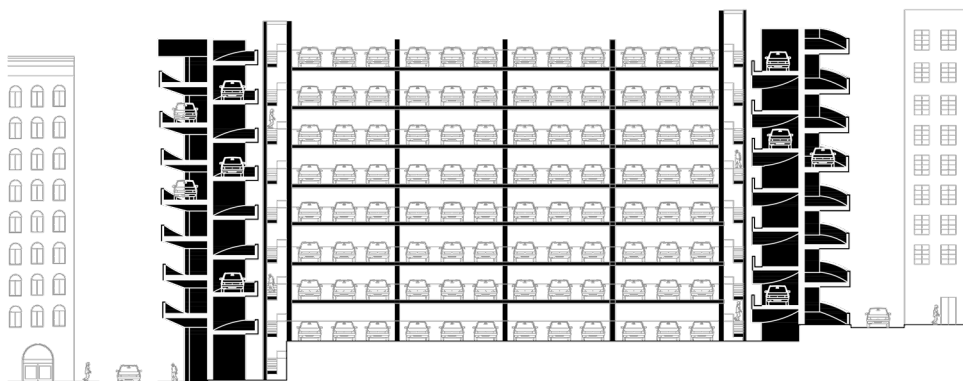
(pag sig): Planta y sección *O'Hara Parking Plaza*, Tasso Kalselas, Pittsburg, 1960. Dibujo de la autora.
